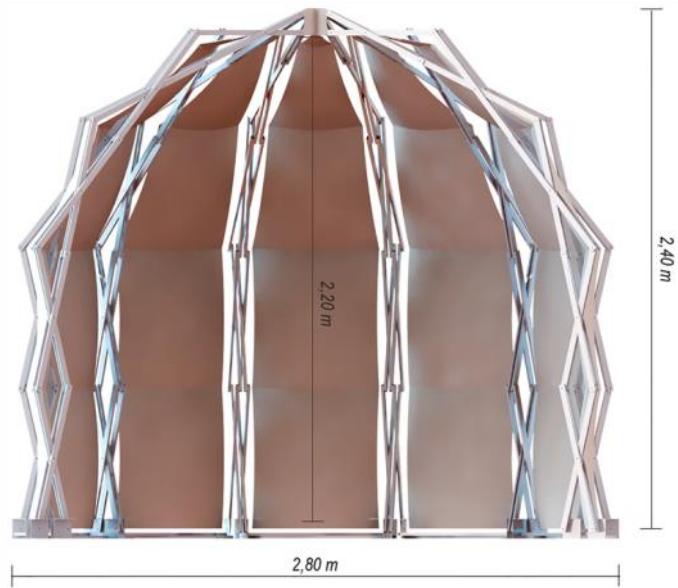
Planta Stand Egg desplegado. Fuente: Elaboración del autor
